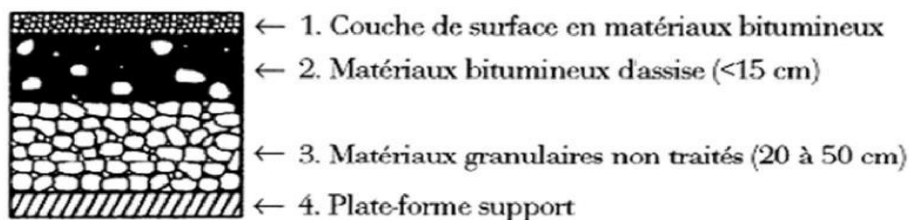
2 Exemple de la structure d'une chaussée souple [9]
